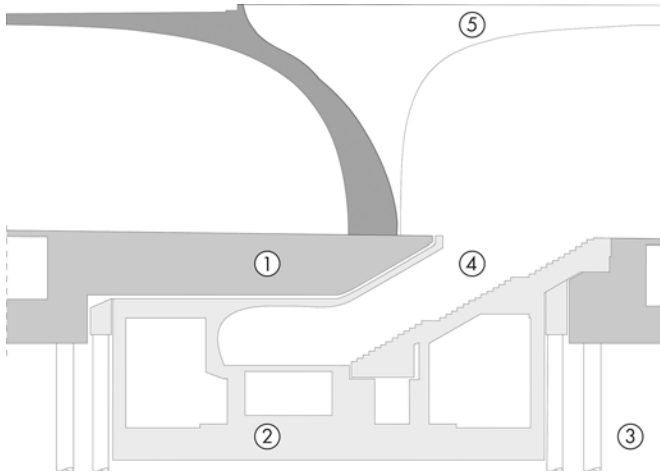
Längsschnitt durch den Bahnsteig mit daraufstehendem Kelch:
